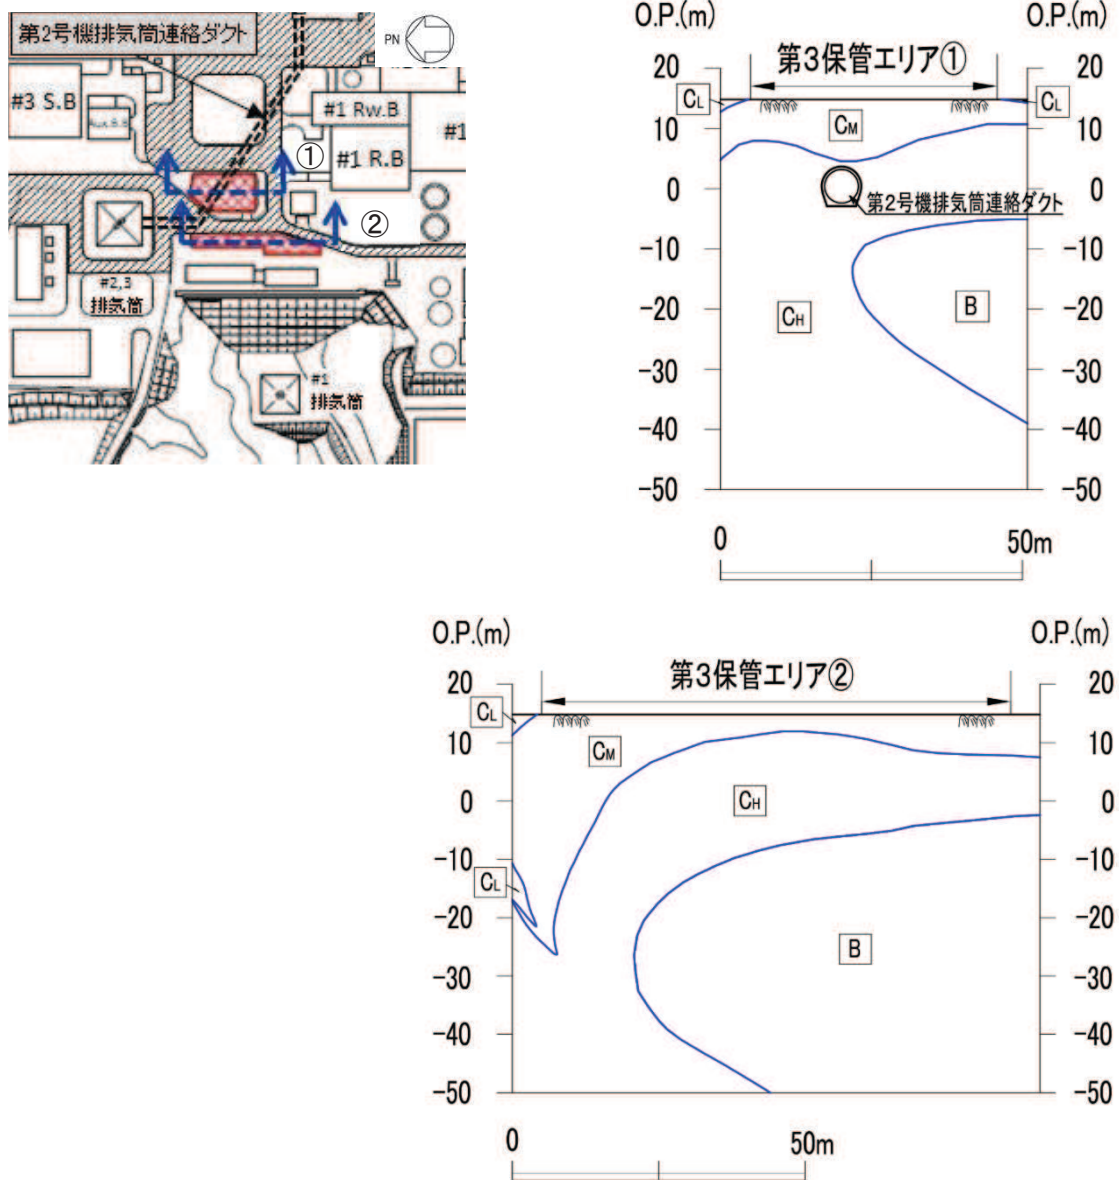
第3保管エリアの平面図及び地質断面図
